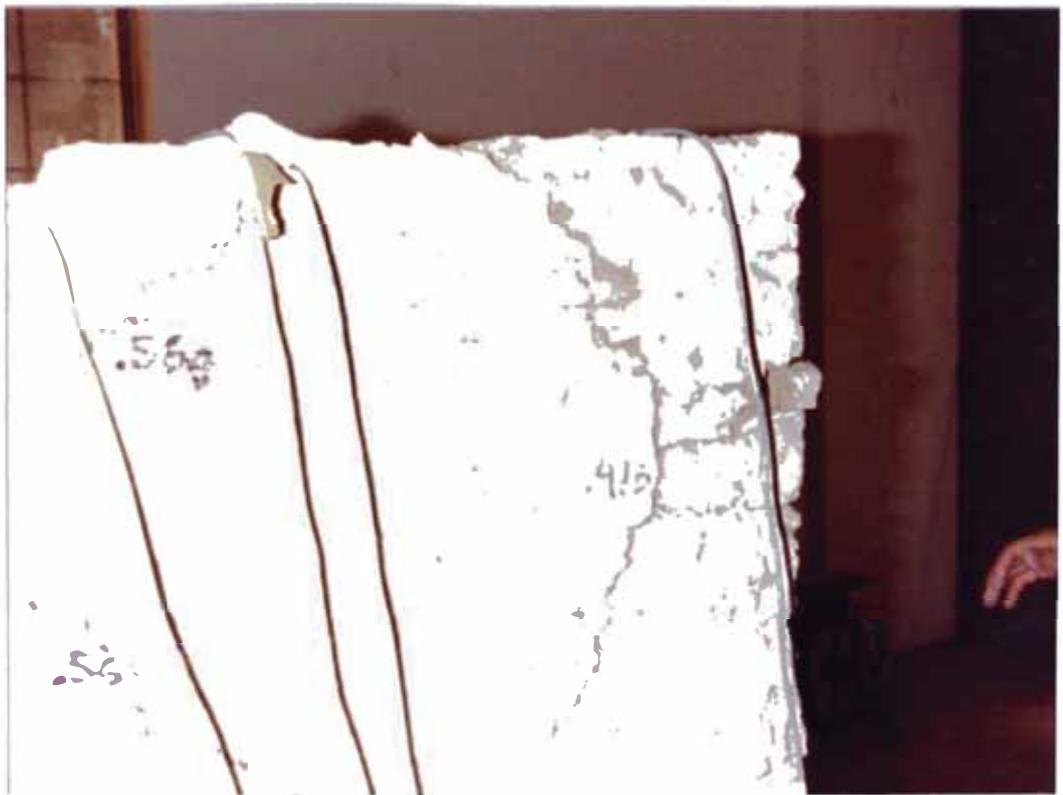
El muro 2 es paralelo a la dirección de la fuerza sísmica. Este muro fallará por corte. Se puede observar una fisura inicial causada por una aceleración de 0.152 (0.025 a escala natural).
